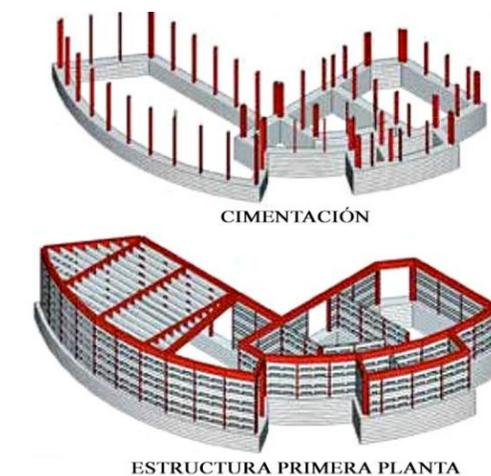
Estructura de madera y pallets de la Casa Jacinta
